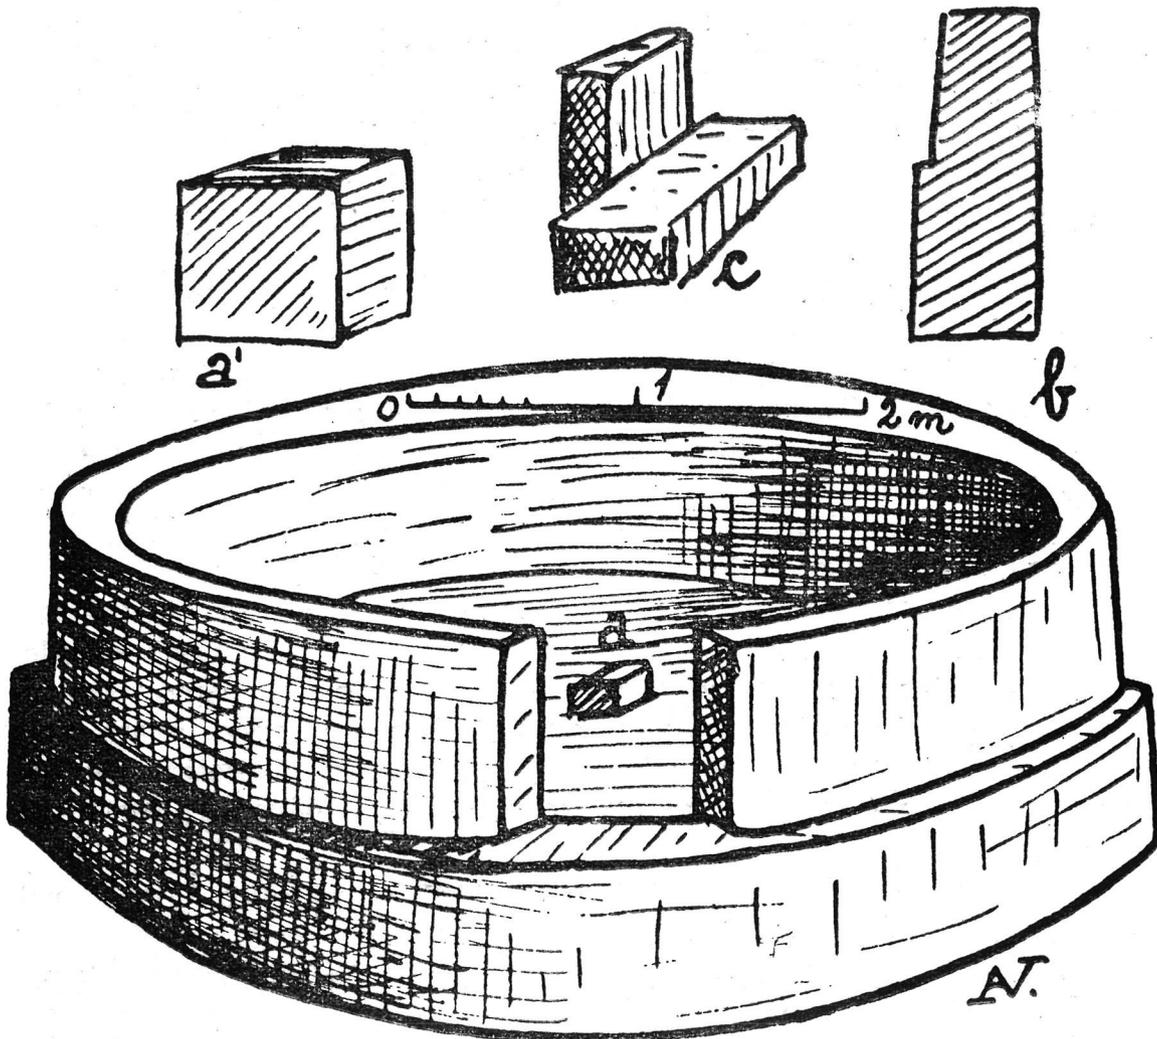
Planta da casa n.º 37: a, pedra central; a', e, c, tipos de pedra central; b, corte da parede da casa n.º 37.
